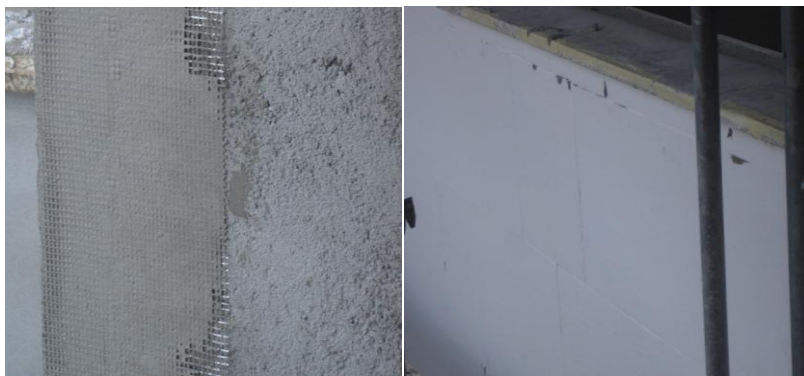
Pormenores construtivos das paredes exteriores, Guarda
